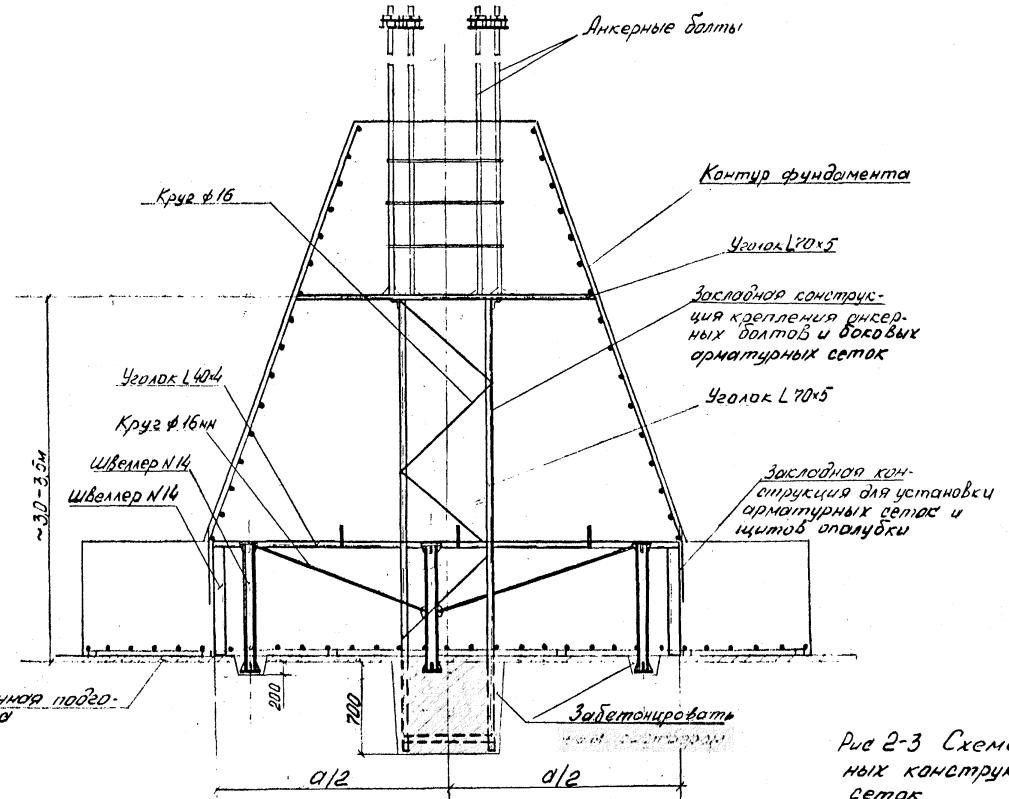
Схема установки закладных конструкций и арматурных сеток
